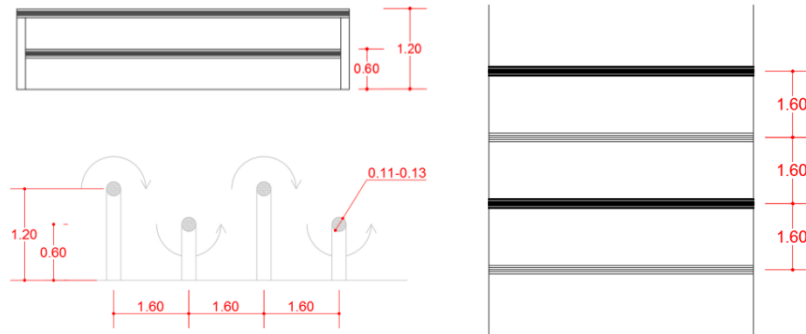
Vista en planta y lateral del obstáculo de vigas horizontales (sobre-bajo).
